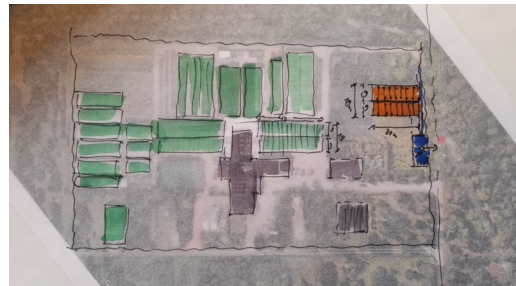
Geplante Lage des Neubaus (orange) auf dem Gelände
